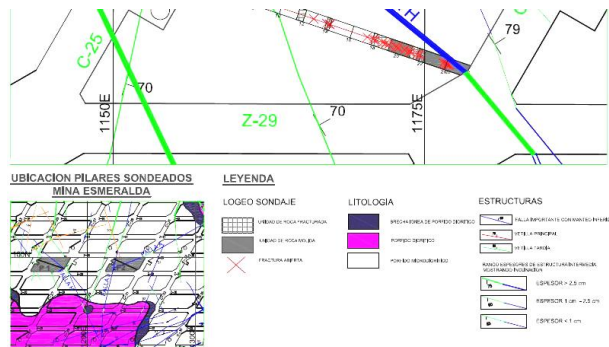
Vista General Nivel Esmeralda Zona Colapsada.
